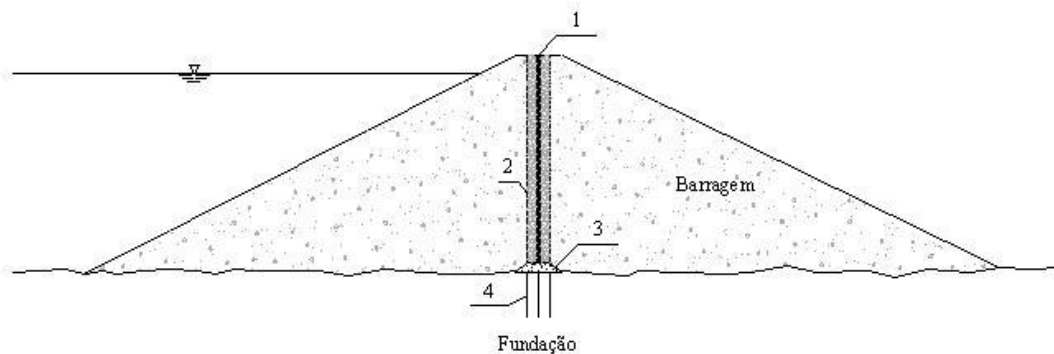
Sección Transversal de una Presa de Enrutamiento con Núcleo Asfáltico.
